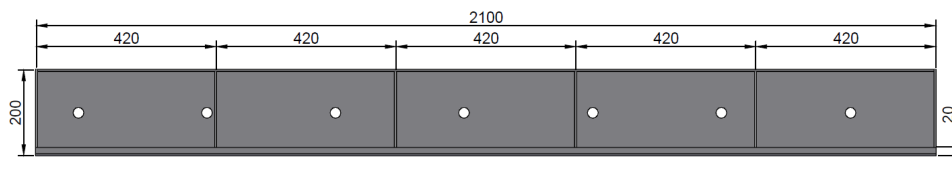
Projeto-tipo de fôrma metálica referencial para execução de pavimento rígido de 210 x 20 x 20 cm
